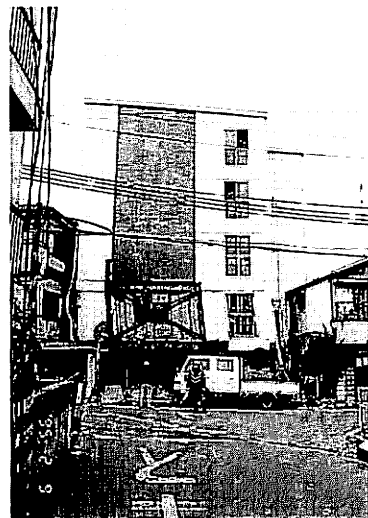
柱の座屈やブレースの破断により傾いたS造5階建てビル
